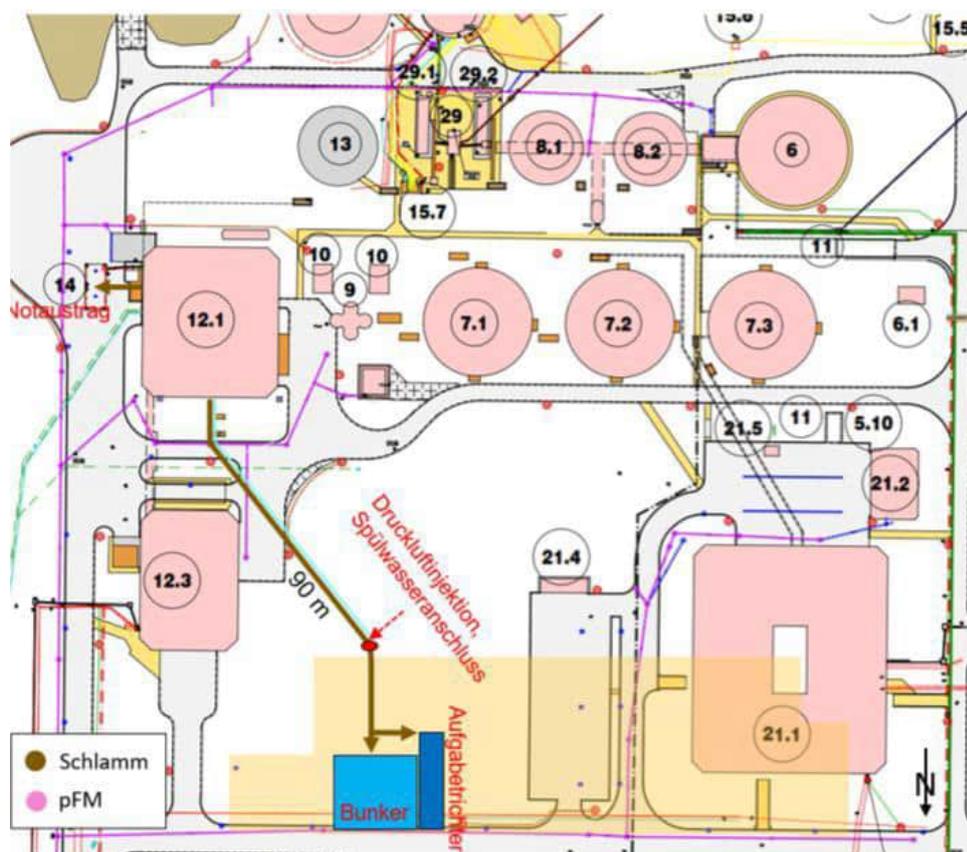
Lageplan mit den Förderwegen des AZV-Schlammes
